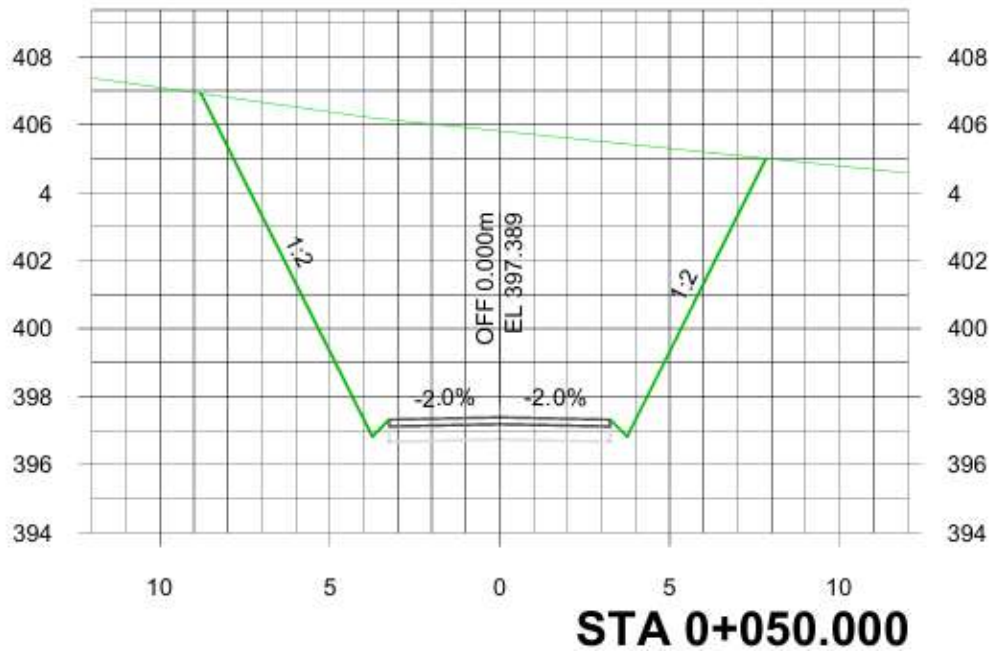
Perfil transversal EJE 4: STA 0 + 050,000
